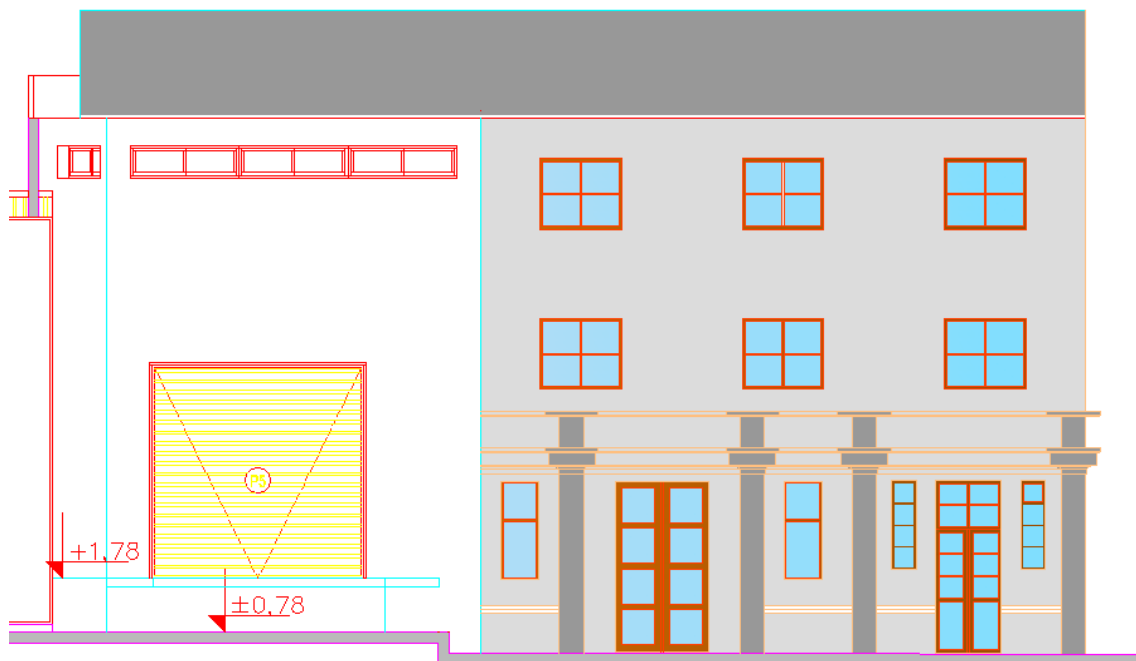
NUEVA FACHADA –GIMNASIO DE BOX U.T.N.
